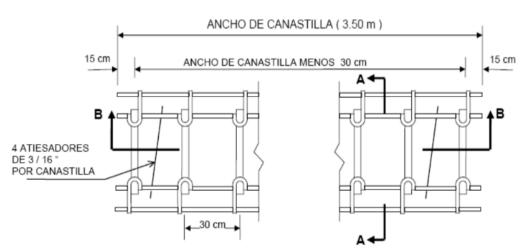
Pasajuntas en juntas transversales de contracción vista en planta
